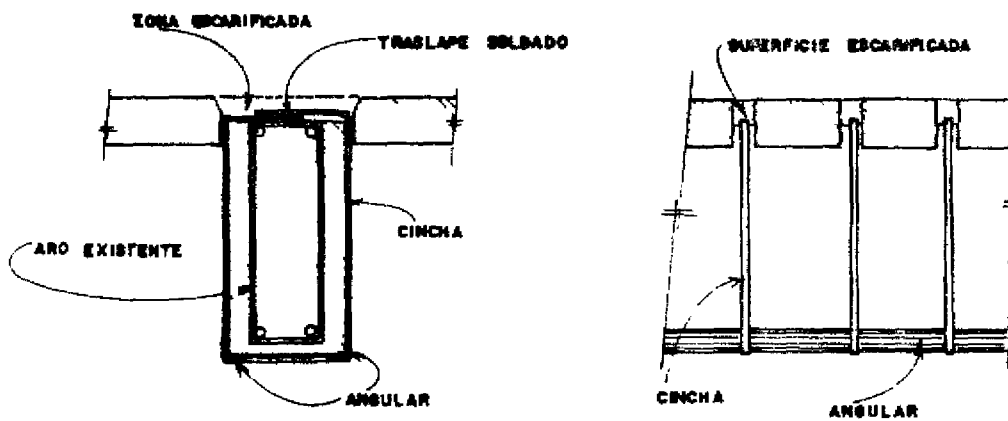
REFUERZO DE CONFINAMIENTO Y DE CORTANTE EN VIGA
